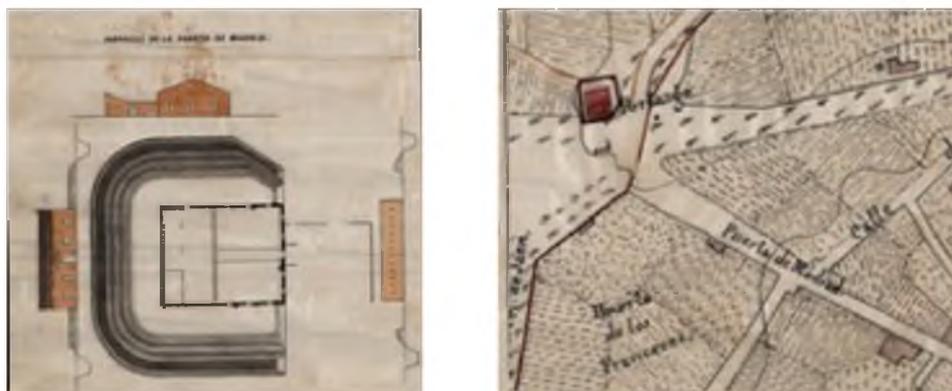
A y B. Portazgo de Madrid, planta y alzado con su foso y parapeto. Superficie: 200 m<sup>2</sup>. Derecha, ubicación en la ciudad.
